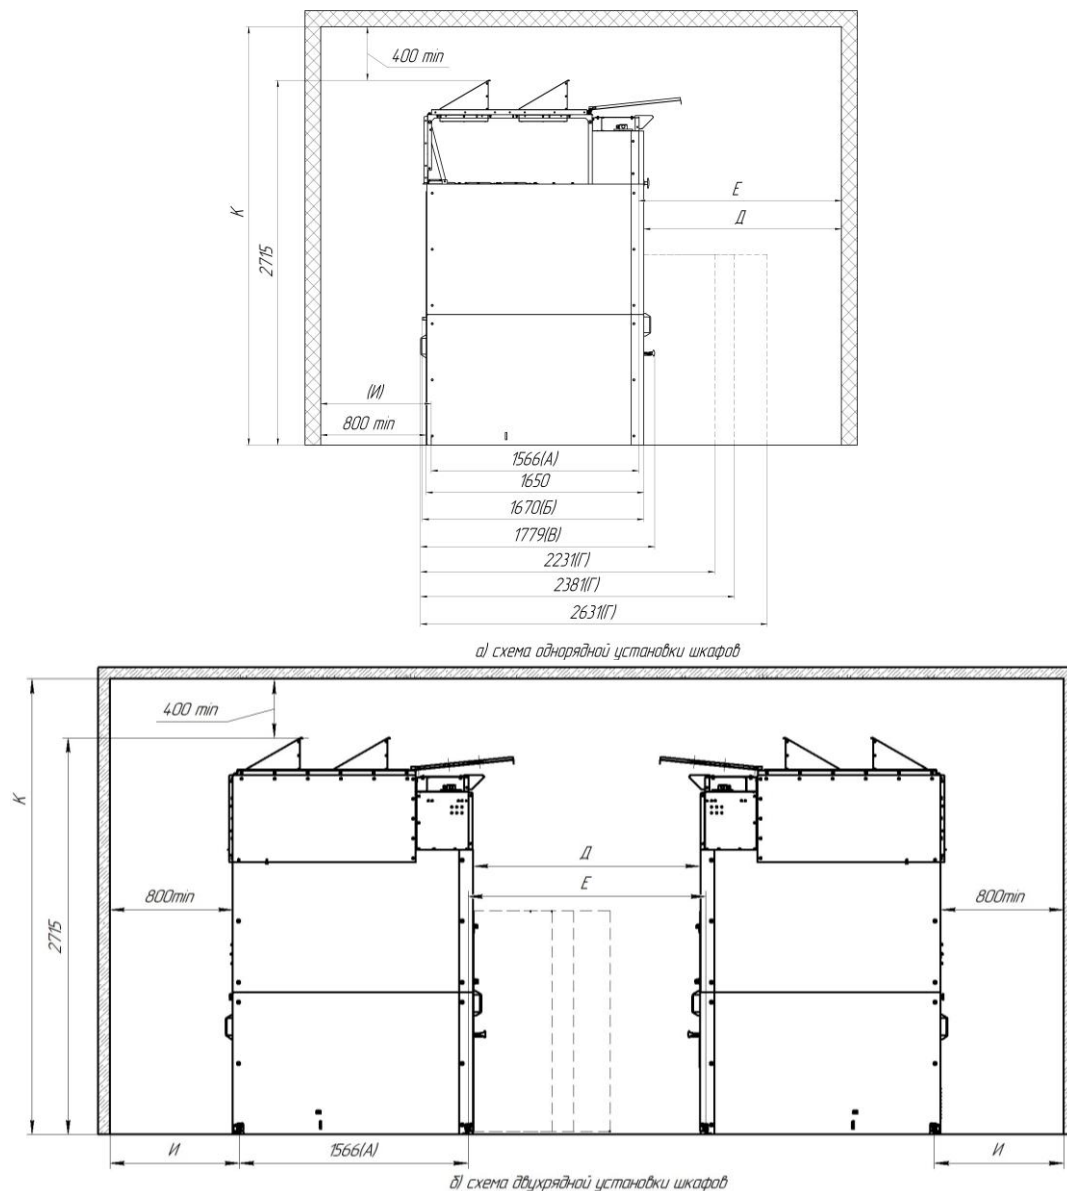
Габаритные размеры шкафов и коридоров обслуживания
